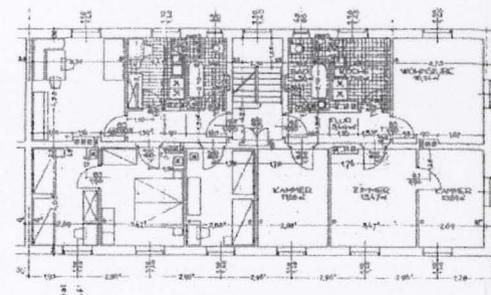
Grundriss Denggenhofsiedlung, Peter Koller 1940
